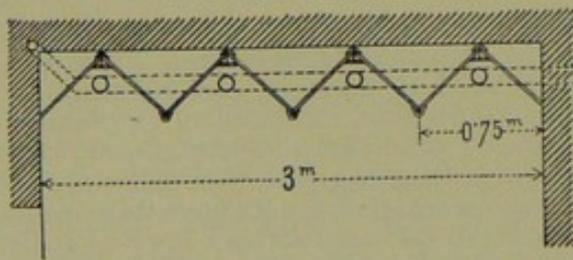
Grundriß zu Abb. 136 nach BEETZ.
